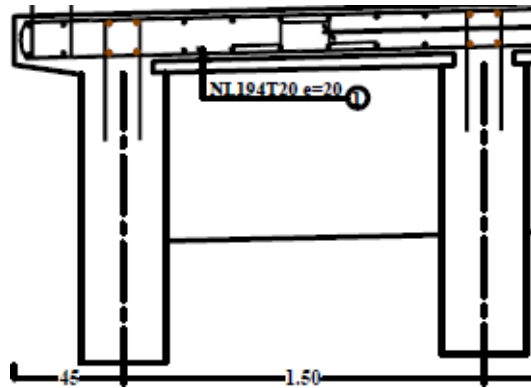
Section transversale du tablier au droit de la poutre de rive
